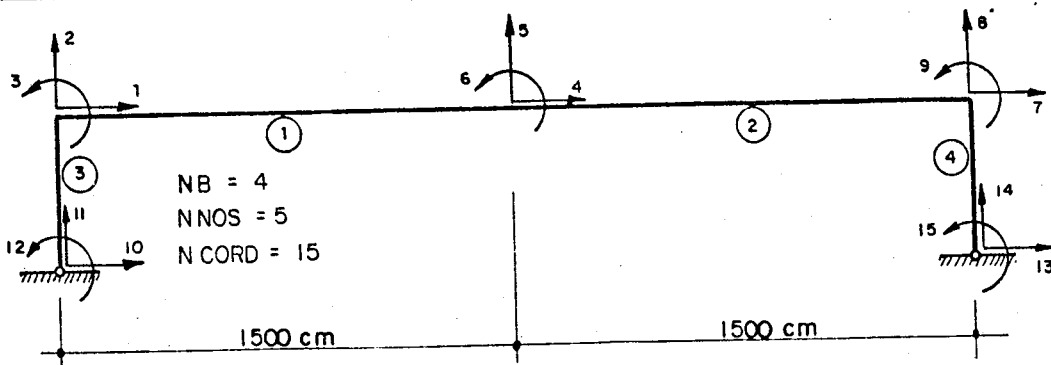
DISCRETIZAÇÃO DO PÓRTICO.
